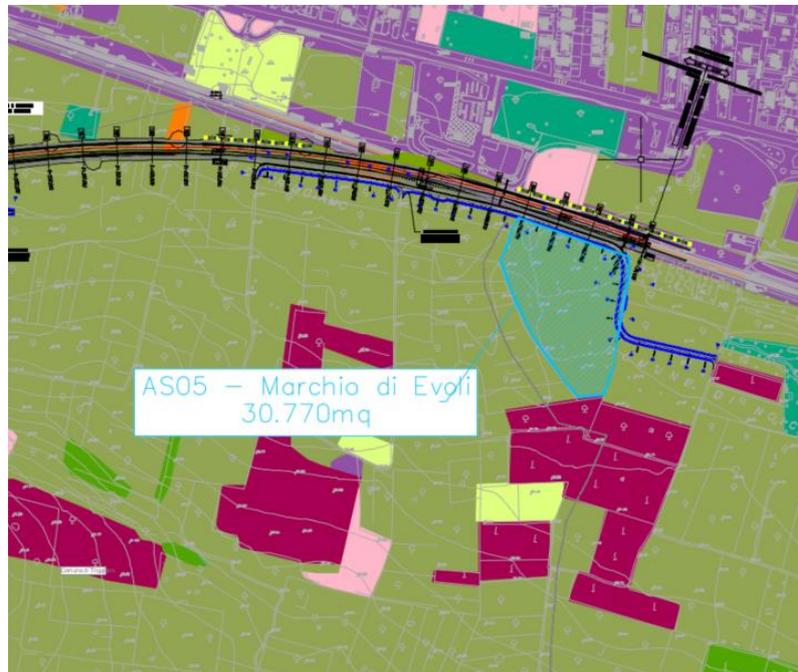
Stralcio della carta della vegetazione rilevata con indicazione delle aree di cantiere
